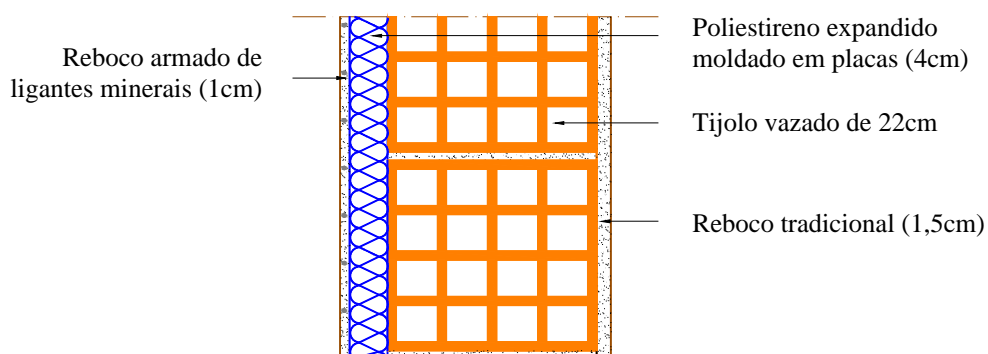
Parede simples com reboco armado sobre isolante contínuo pelo exterior (Par3)
